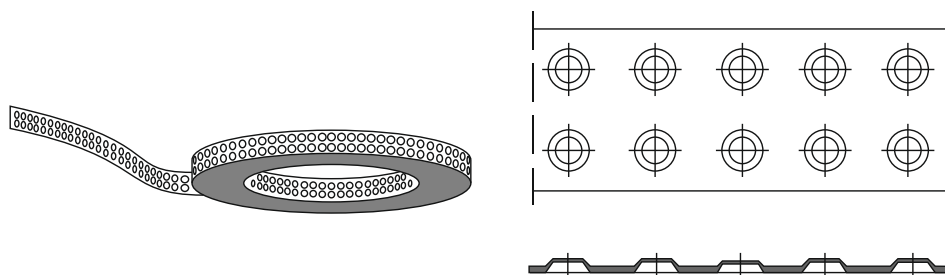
Арматура из стальной перфорированной полосы [27]
